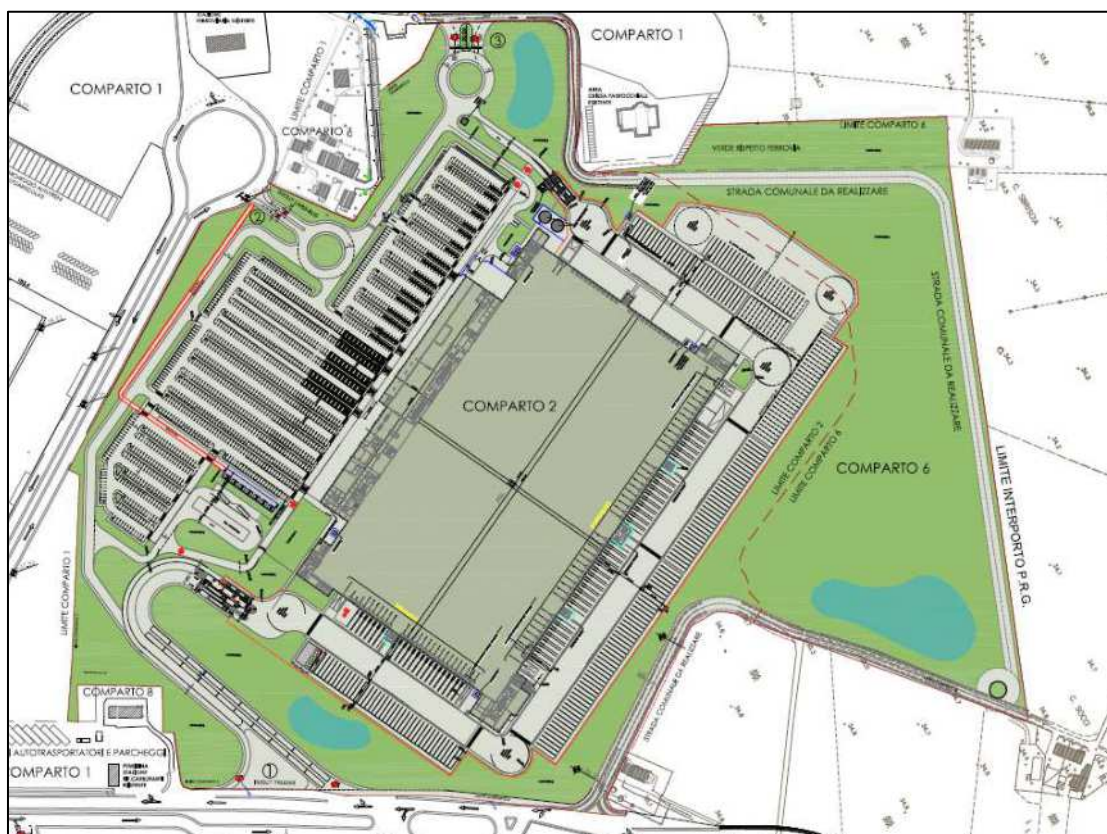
Planimetria di dettaglio del progetto del nuovo polo logistico
